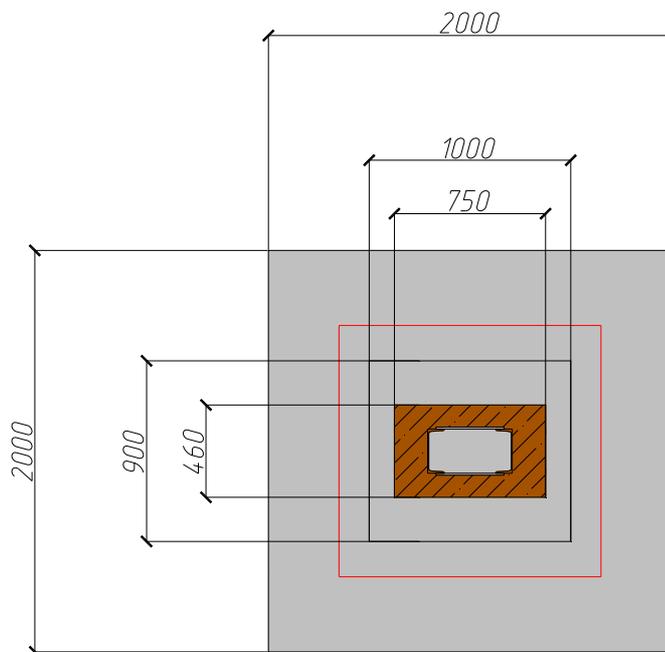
Эскиз поперечного сечения и план фундамента
